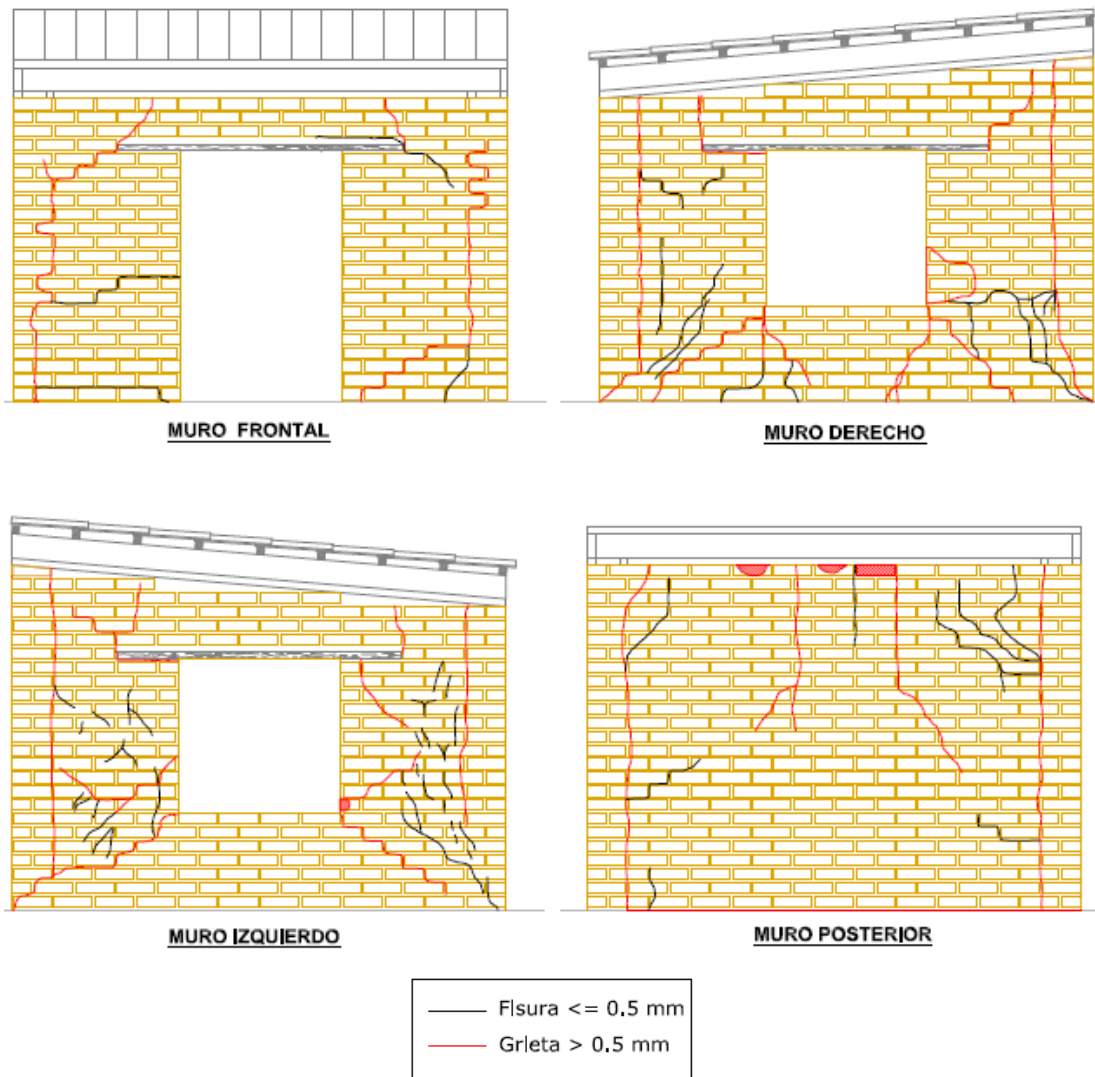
Fisuras y grietas exteriores en muros – Módulo M100-T4100
